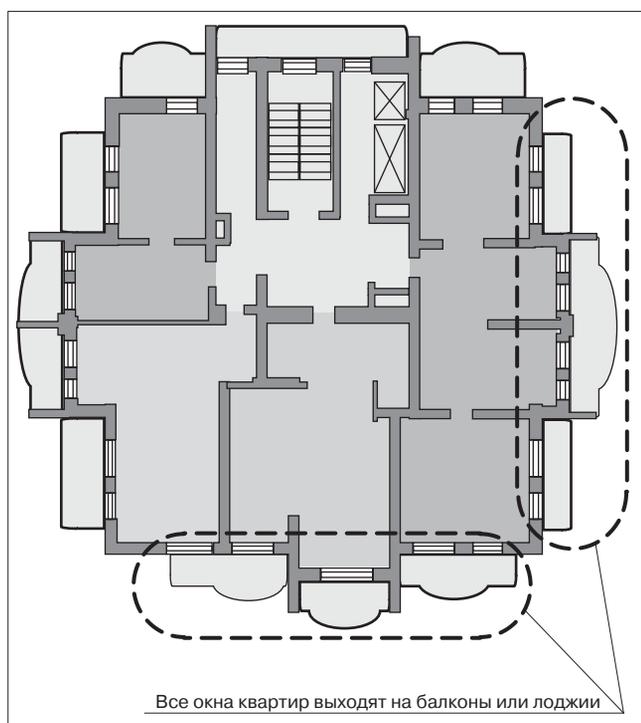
Схема плана типового этажа 23-этажного жилого здания (проект 2008 г.)
